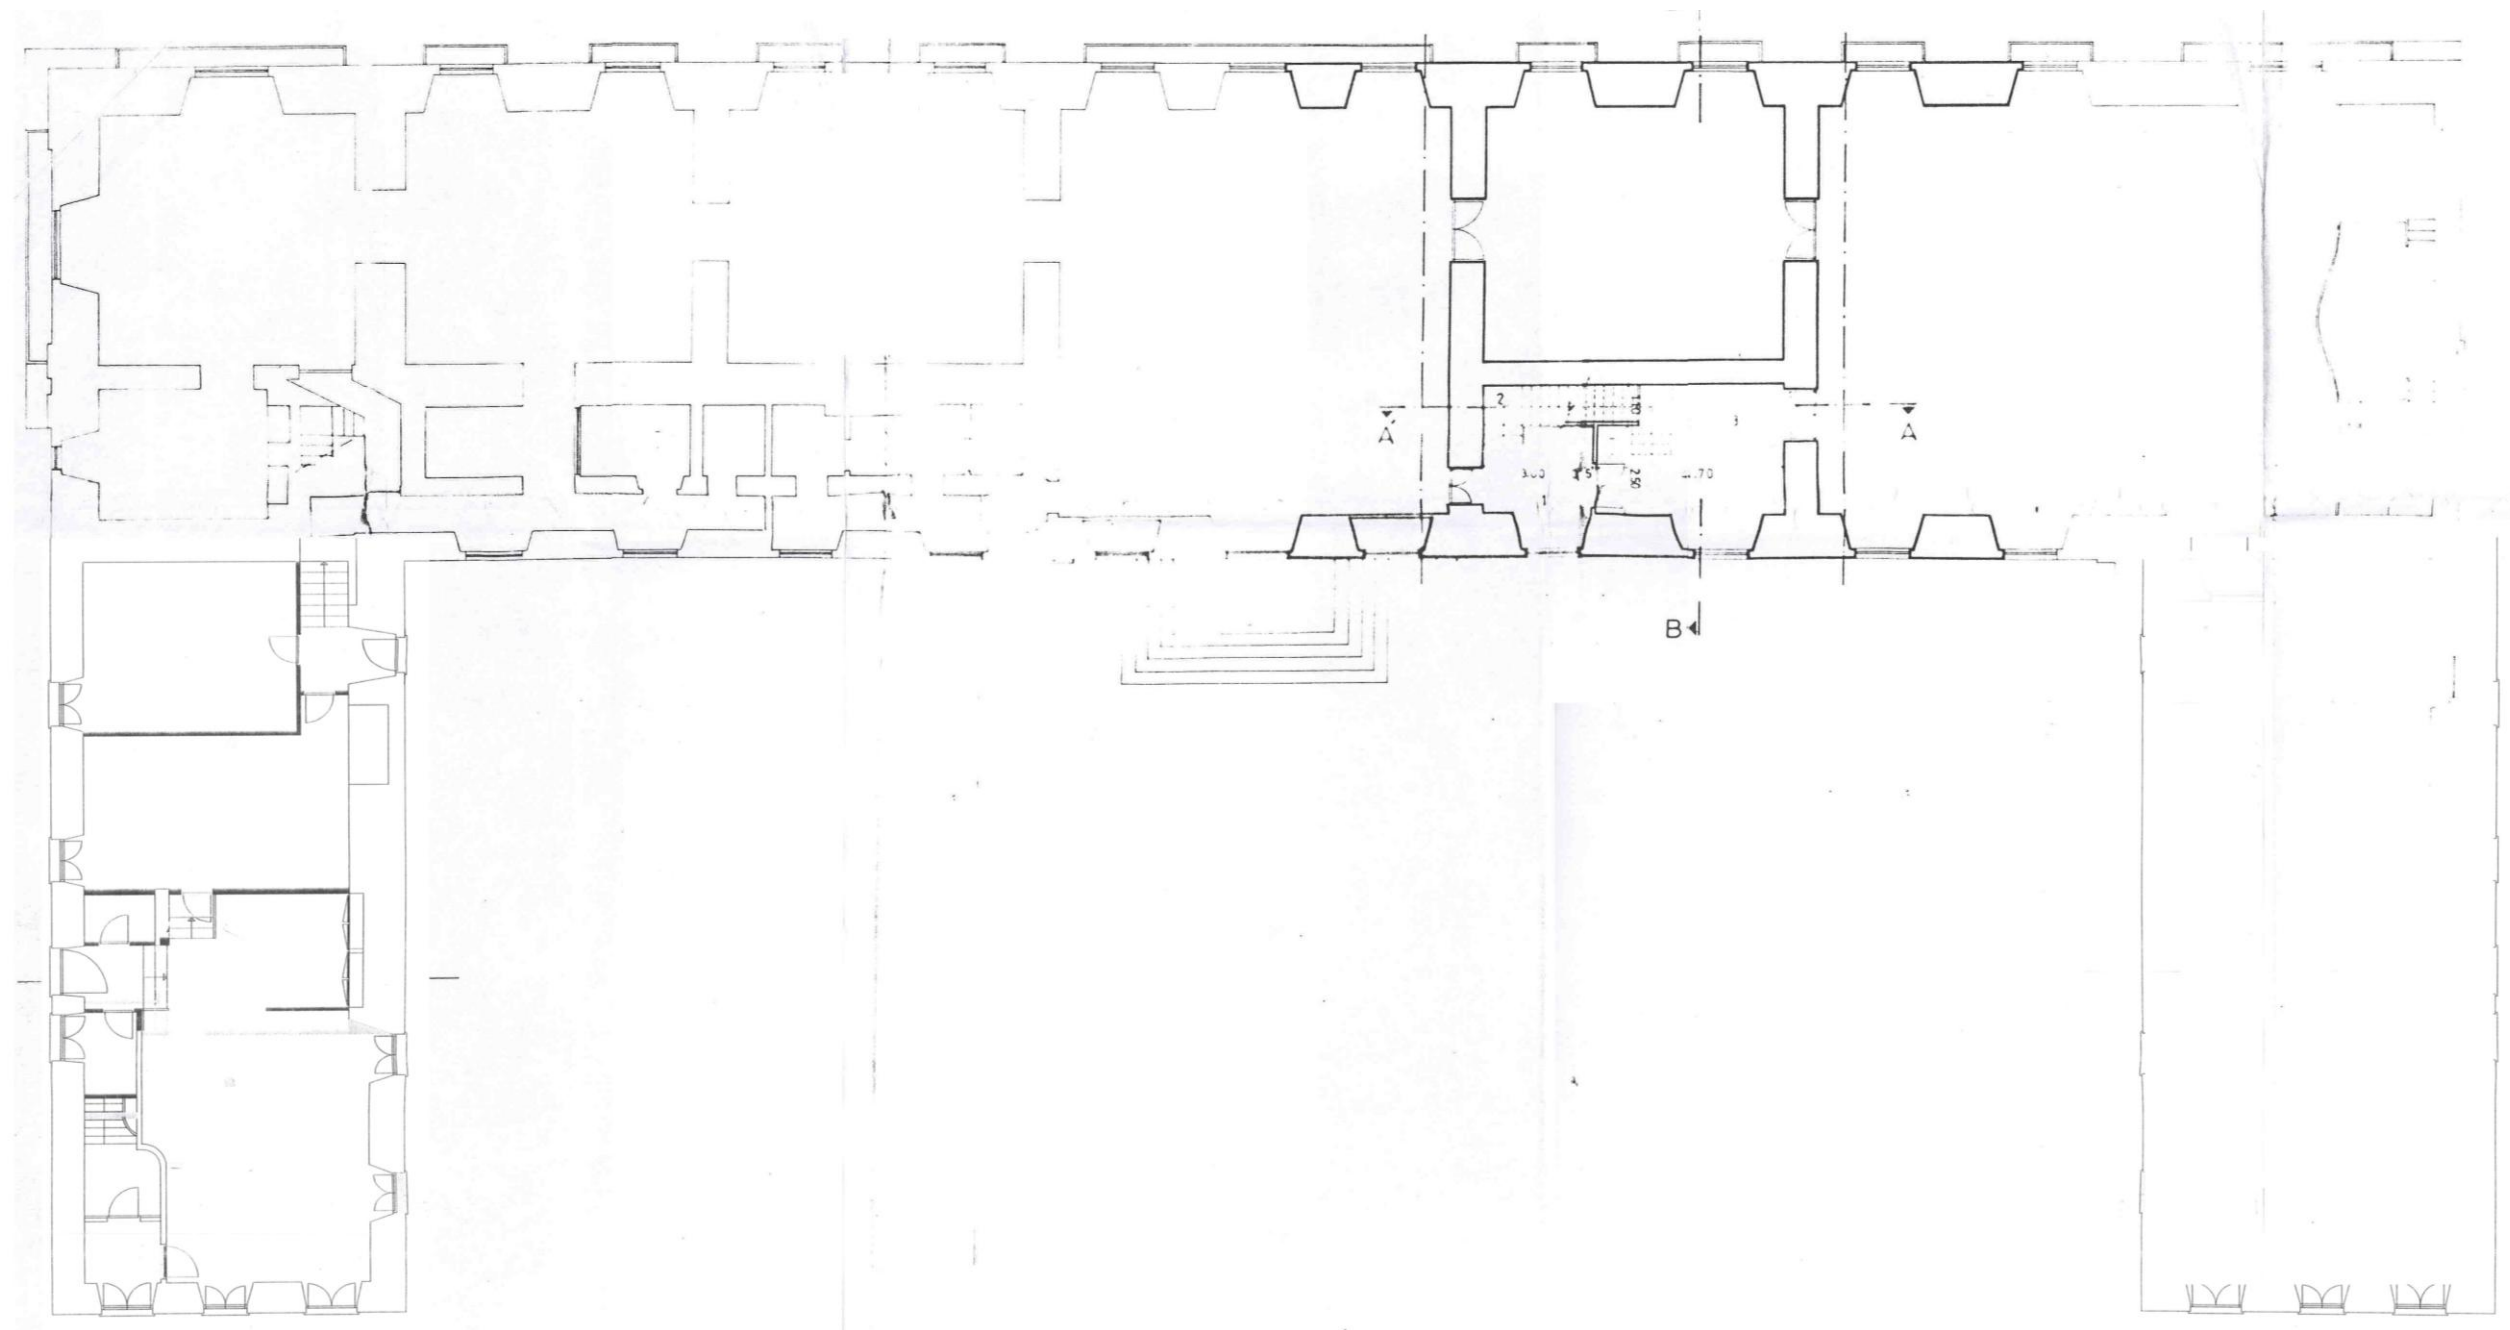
Planta do piso nobre da Casa do Paço²⁹
